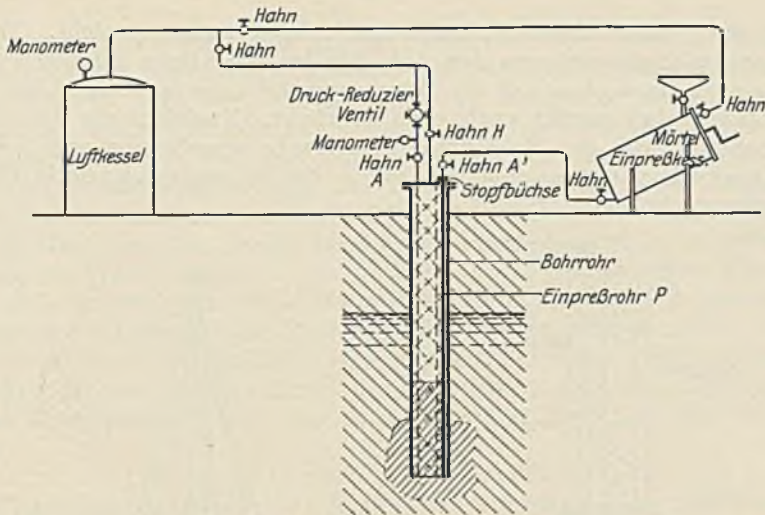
Herstellungswiese der Preßbetonpfähle Bauart Wolfsholz. Dichtes Anpressen des Betons an das Erdreich durch Luftdruck. Das Mantelrohr wird mit der fortschreitenden Betonierung durch Luftdruck gehoben.
